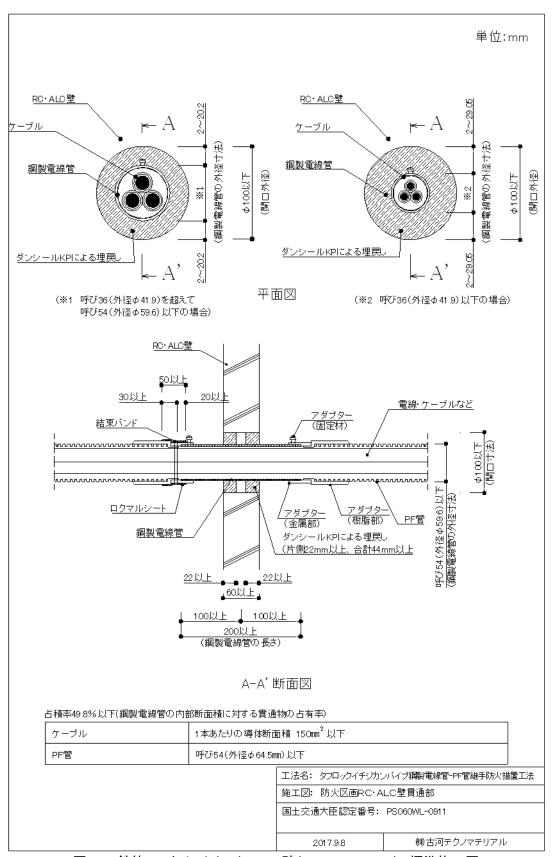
鉄筋コンクリート(RC)・ALC 壁(PS060WL-0911) 標準施工図
